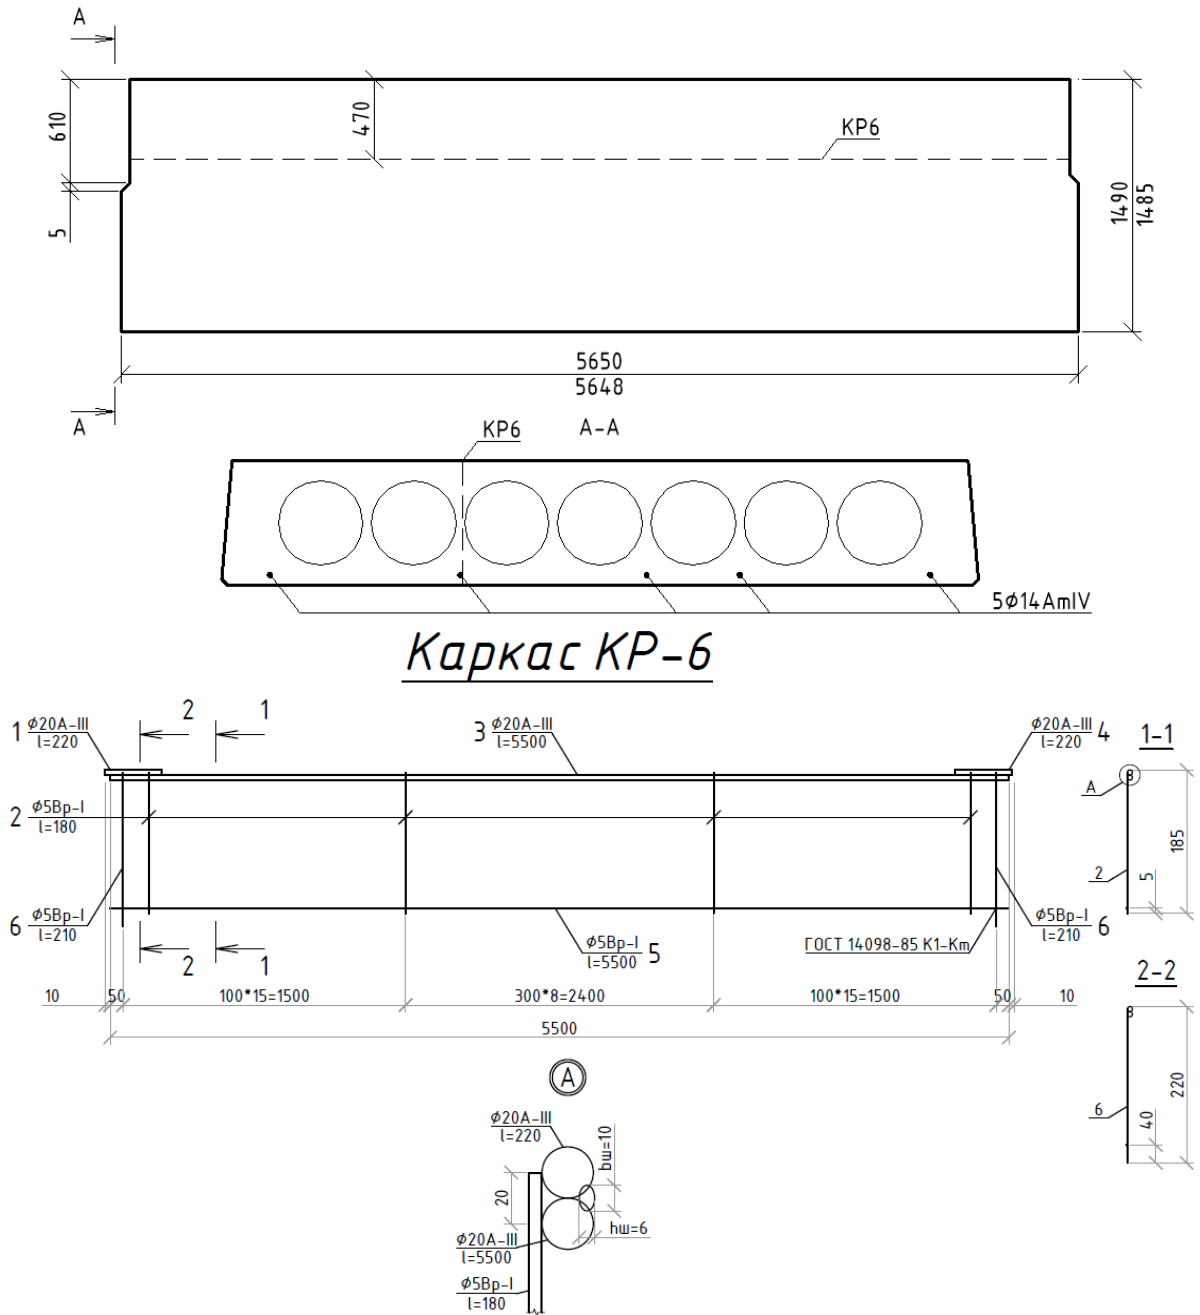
Связевая плита для крайнего ряда марки ПК 56.15-16 Ат IV с продольным каркасом (Кр-6) для восприятия горизонтальных усилий в диске перекрытия.
